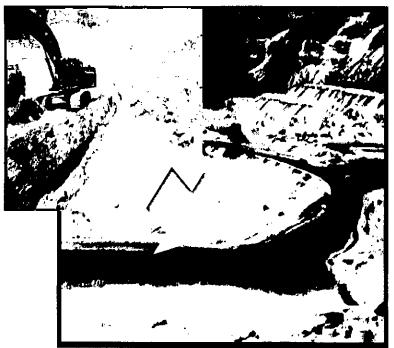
Trabajos en la canaleta y trazado de canaleta de conducción
